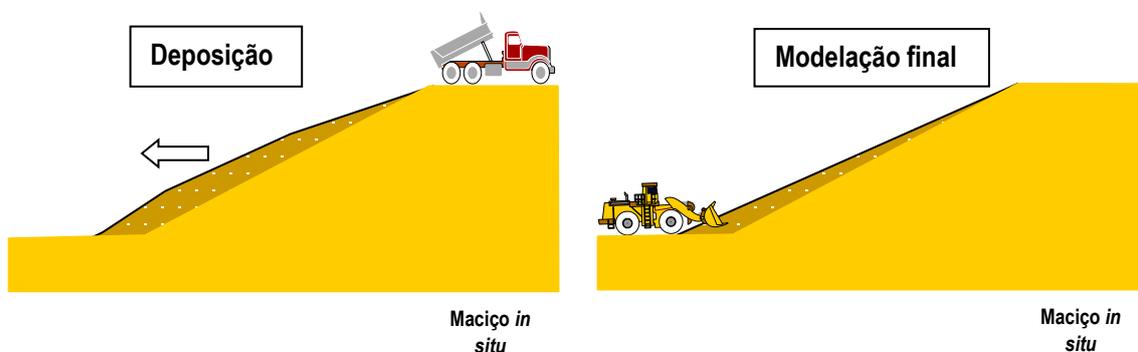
Perfil esquemático do método construtivo para o preenchimento dos vazios de escavação.
